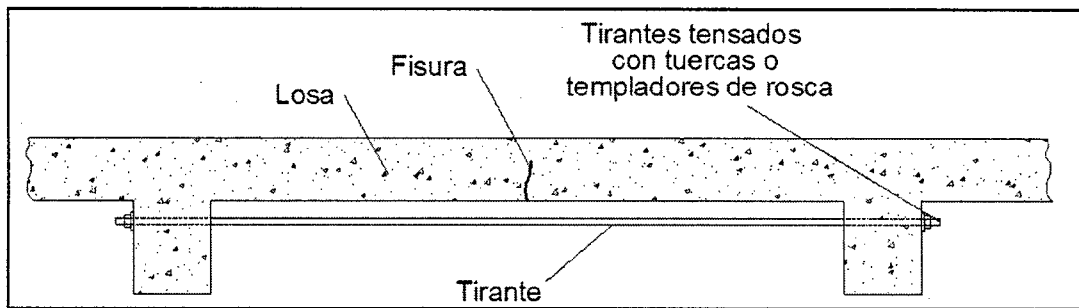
Reparación de fisuras en una losa con tirantes.
